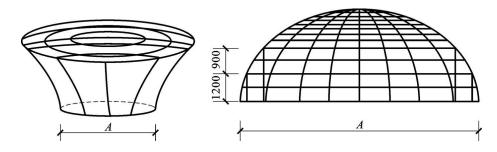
有围护结构不垂直于水平面建筑物示意图
